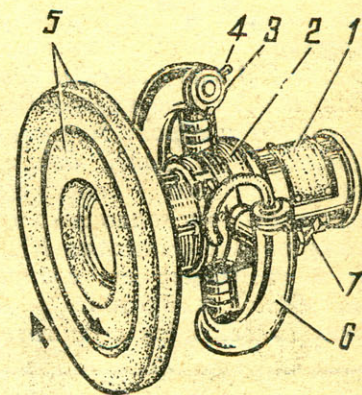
Затирочная машинка: 1 — электродвигатель, 2 — корпус редуктора, 3, 6 — ручки, 4 — выключатель, 5 — затирочные диски, 7 — водяной краник.
